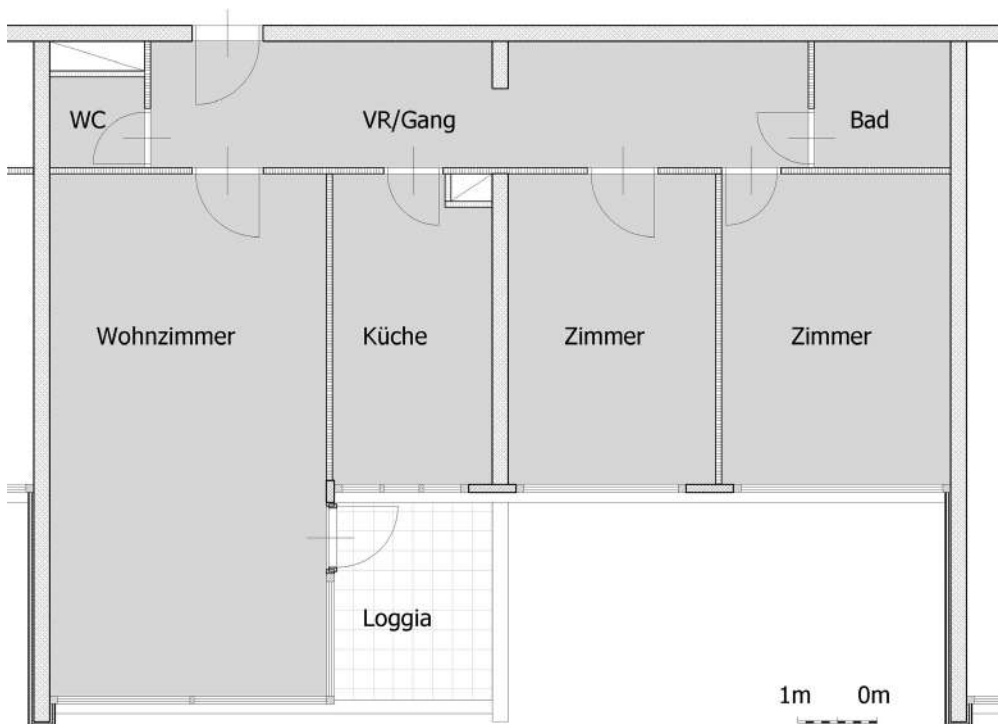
Bestandsplan Grundriss Regelwohnung, RfM Architektur
